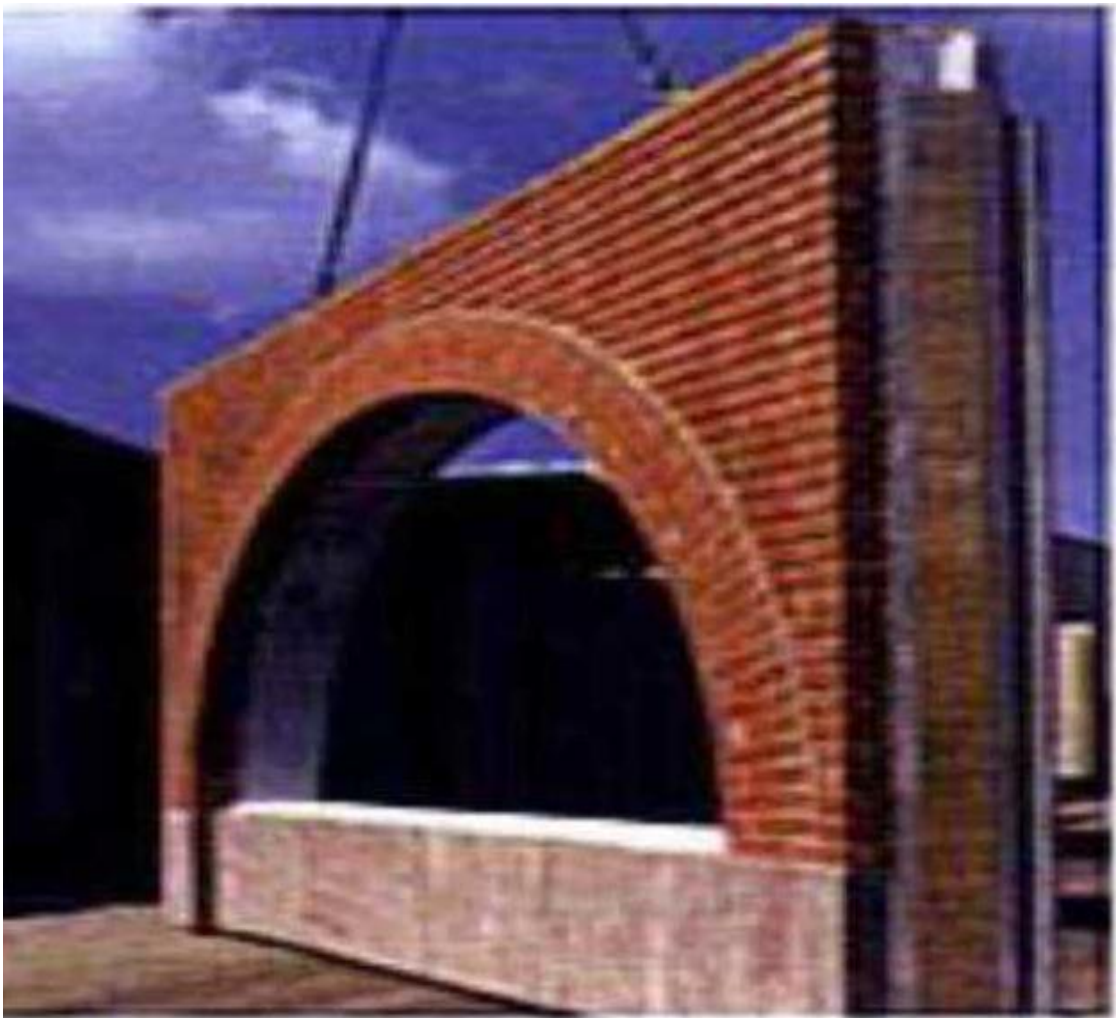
Тришарова залізобетонна панель фірми PARASTEK BETON (Фінляндія) із зовнішньою обробкою «під цеглу»
